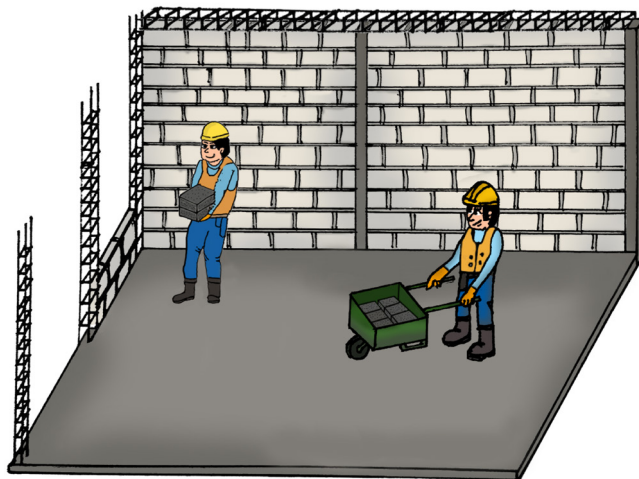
Muro estructural de mampostería confinada, tipo 1 (se construyen los muros y luego las columnas y vigas que lo confinan)
